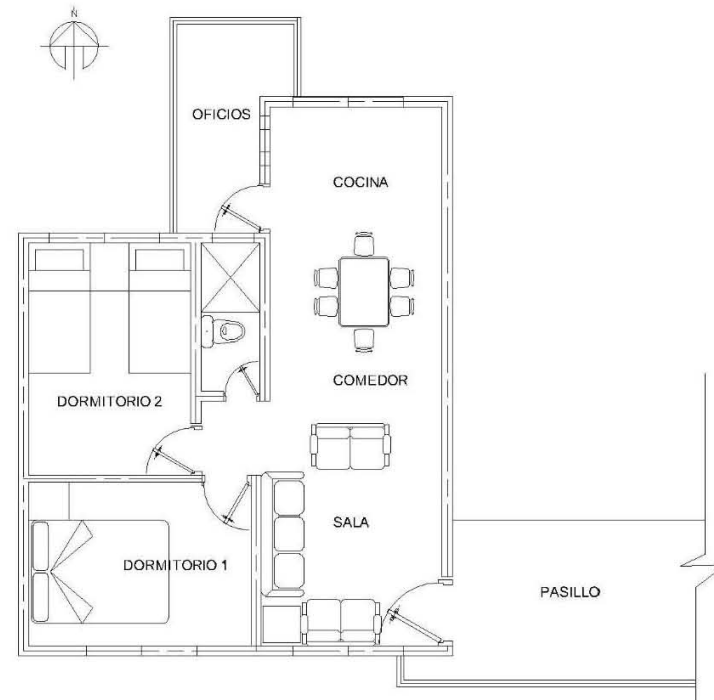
Distribución en planta de los espacios propuestos por modulo habitacional
